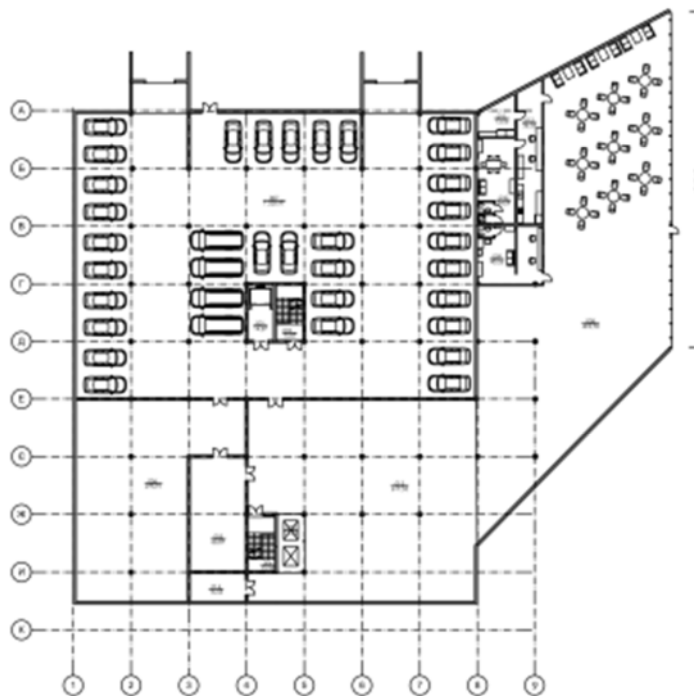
План -1-го поверху на відмітці -5.400 м
